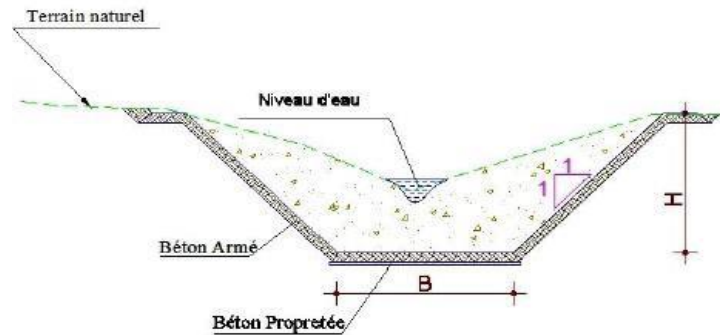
Schéma d'un canal trapézoïdal en béton armé
